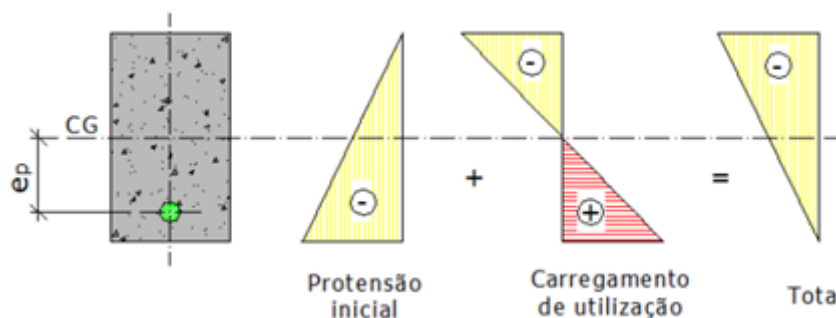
Efeito da protensão em estruturas de concreto (fonte: NELSEN, 2013).
